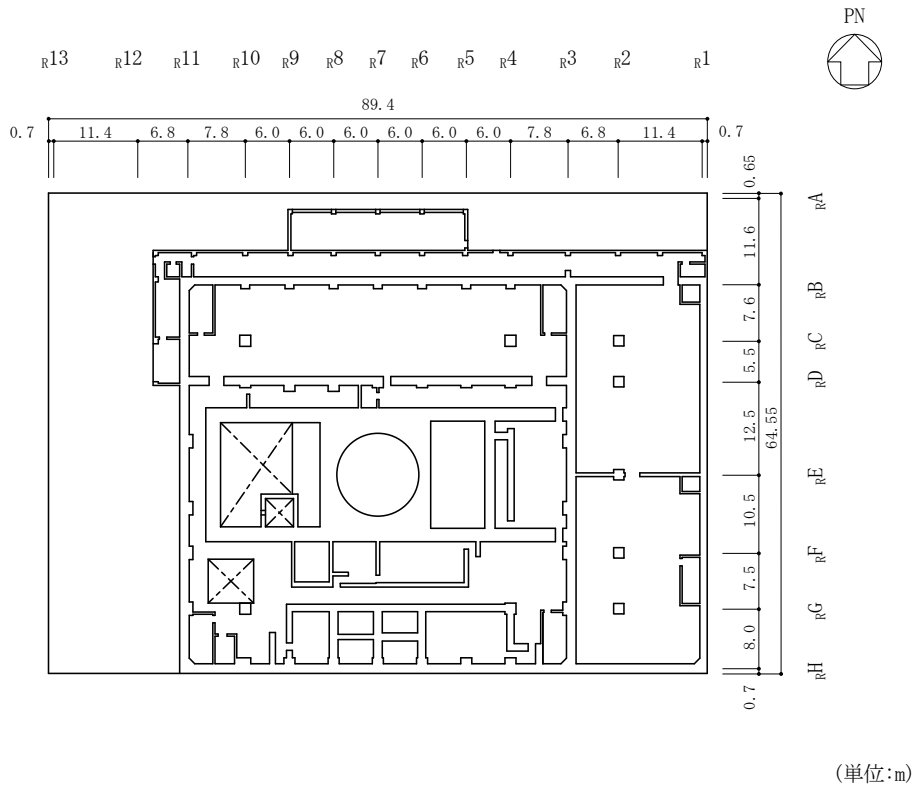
(6) 原子炉建物の概略平面図 (EL 34.8m)
